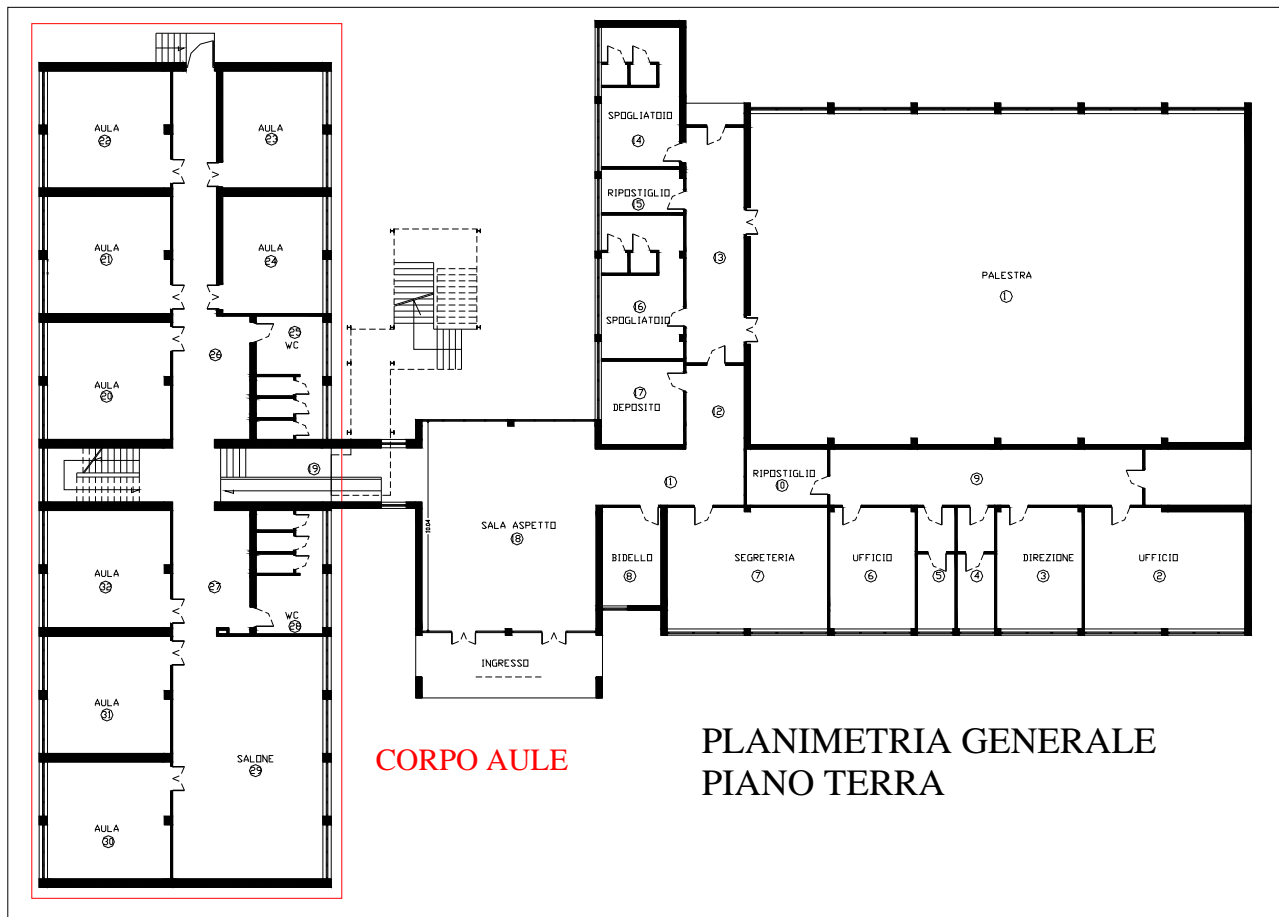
Planimetria generale piano terra del plesso Mazzetti
